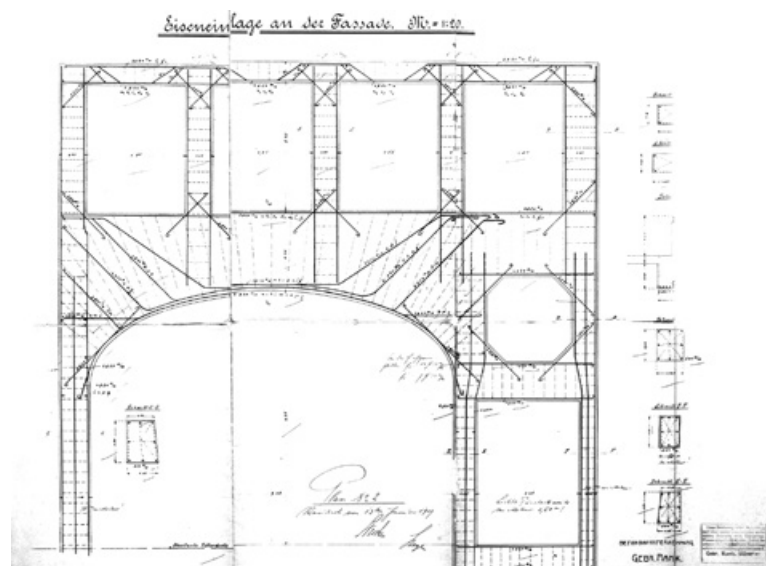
Bewehrungsplan der Fassadenfront (Basiner 2012, S. 160).
